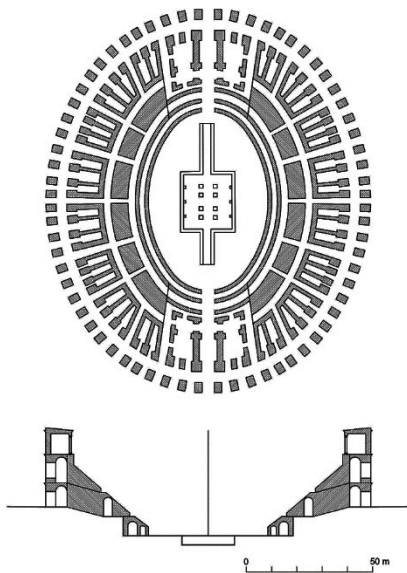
Planta y sección hipotética del anfiteatro de Itálica, España.
